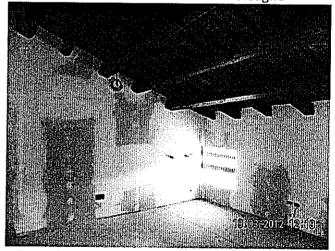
Stanza 2.4: Vista parete esterna con tetto e finestra
